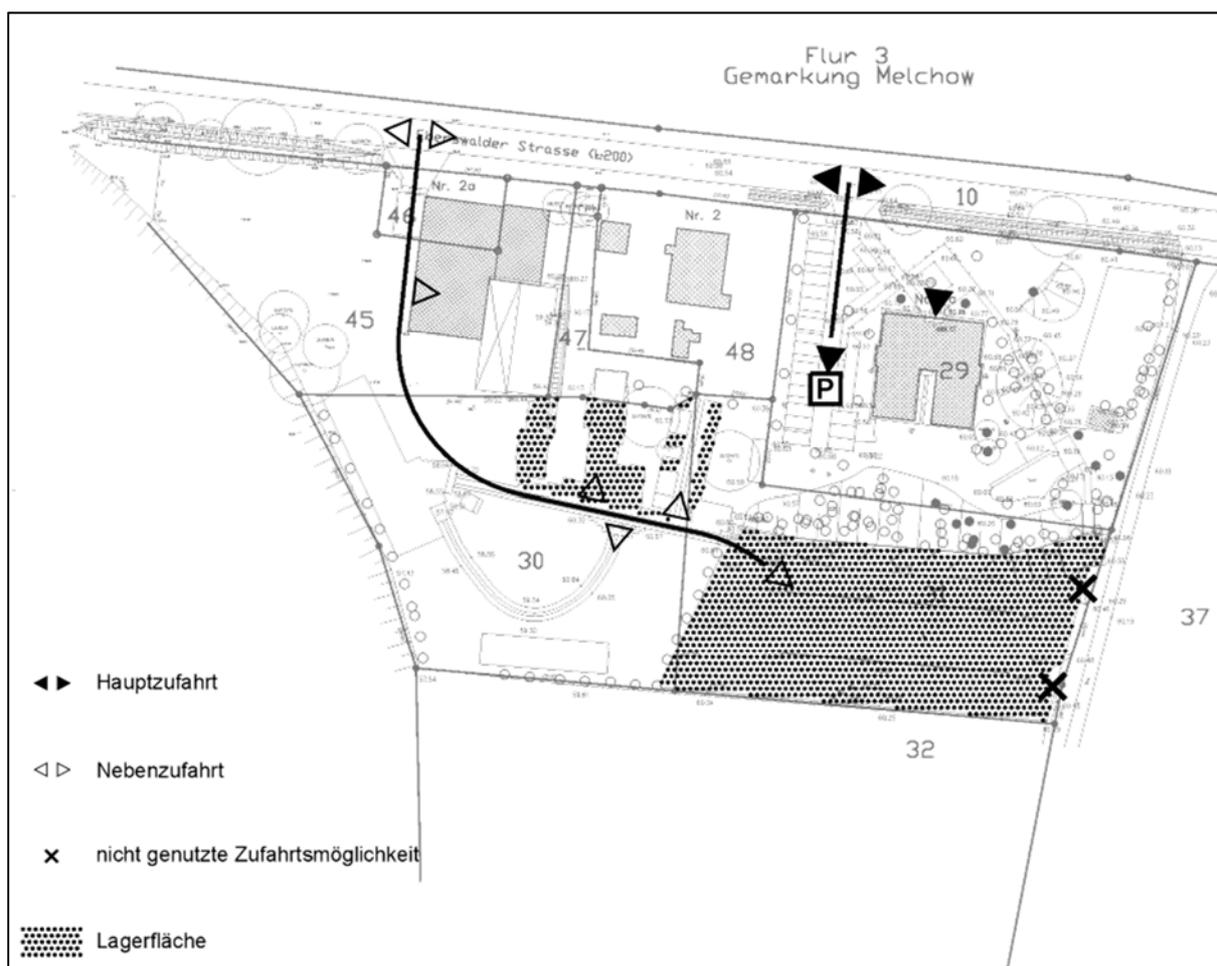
Bestehende Zufahrtswege im Plangebiet
